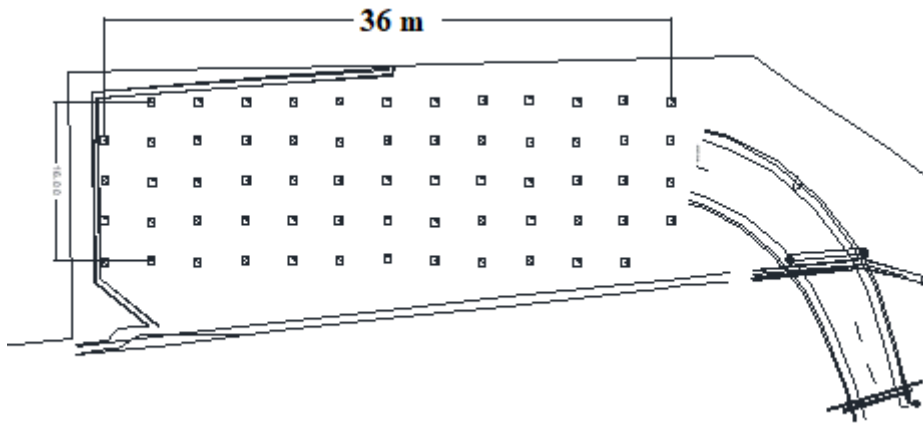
Plano estructural con ubicación de pilotes del patio de transformadores (vista en planta) estructural.
